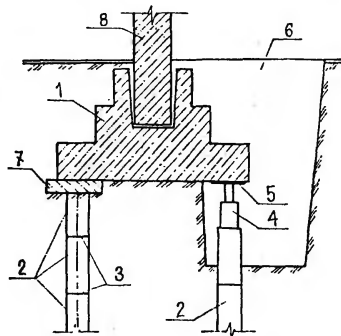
Передача нагрузки от фундамента на составные железобетонные сваи, погружаемые задавливанием
